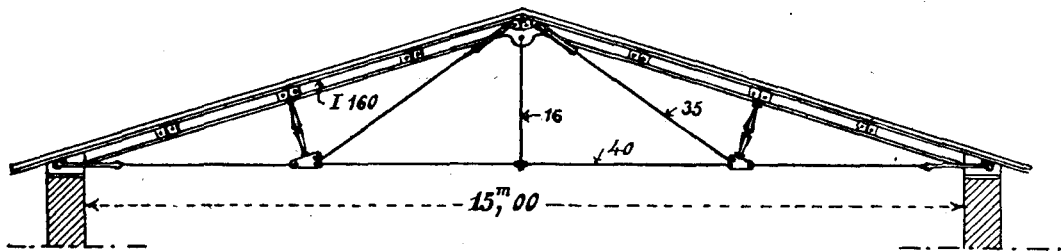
Armadura *Polonceau*, completamente metálica, para una cubierta de chapa de zinc; separación entre cerchas, 3,50 metros.
